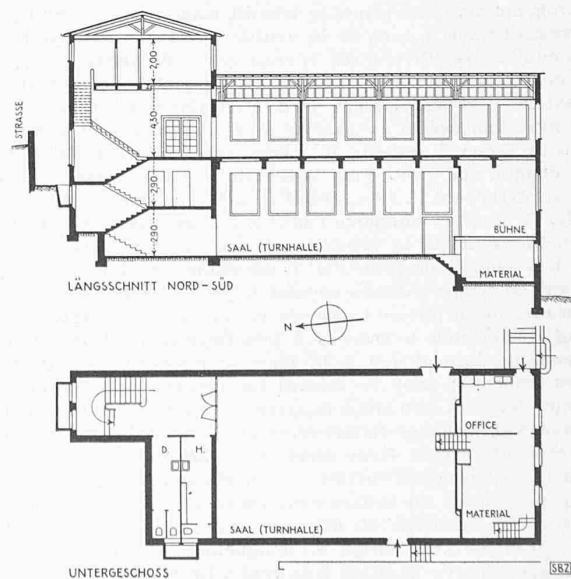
u. 18. Längsschnitt und Untergeschoss-Grundriss 1:400
